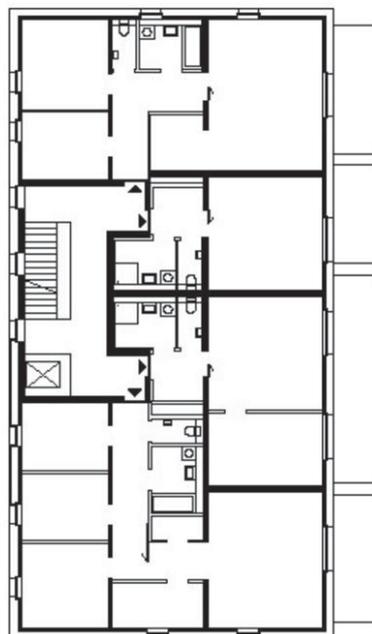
Grundriss Wohnanlage Hummelkaserne
